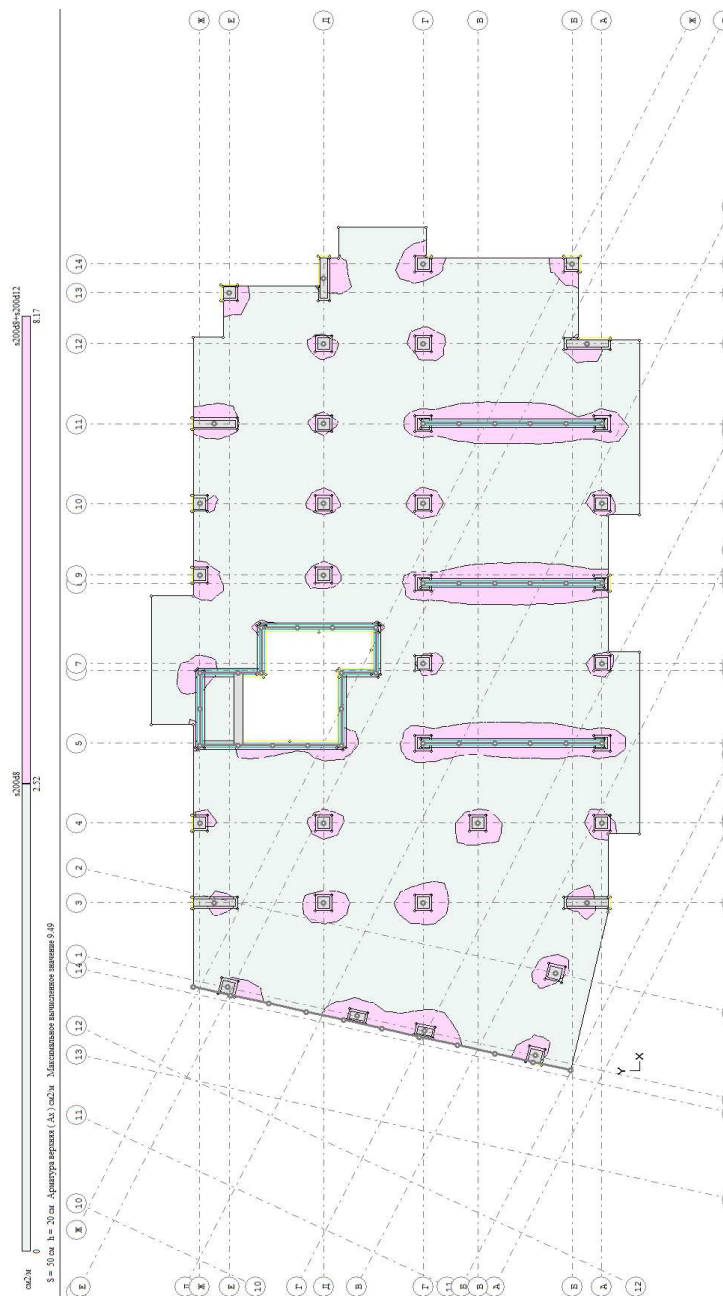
армирования плиты перекрытия типового этажа (толщина плиты 200мм, бетон В25)
